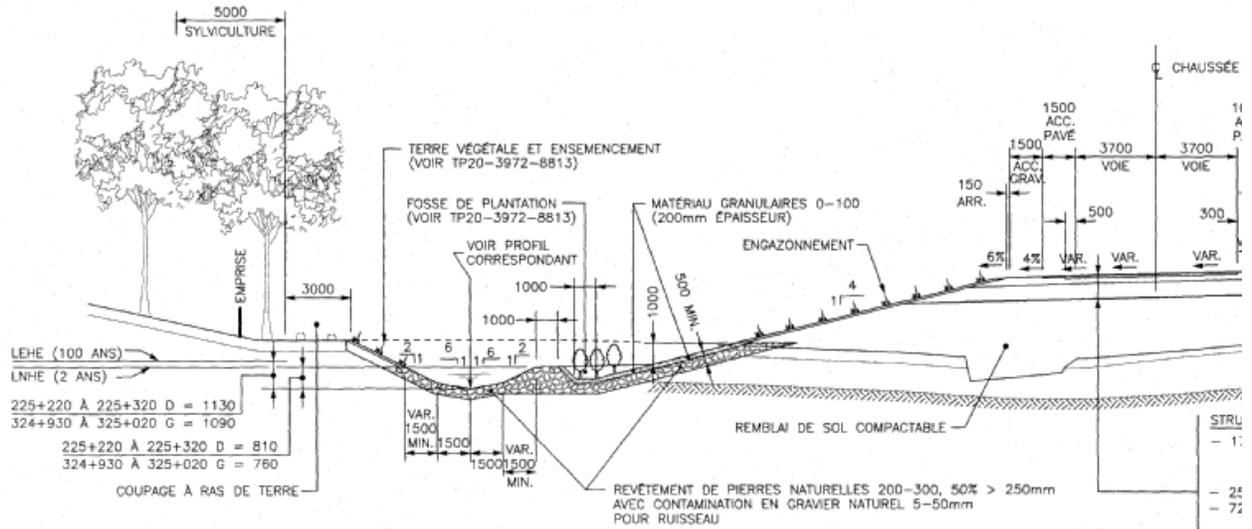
Extrait du plan de construction présentant une section-type du réaménagement du ruisseau des Brûlés au km 125 (plan CH20-3972-8813 de Piette, Audy, Bertrand, Lemieux et associés et consortium Pluram-Écogénie-Pro Faune).
